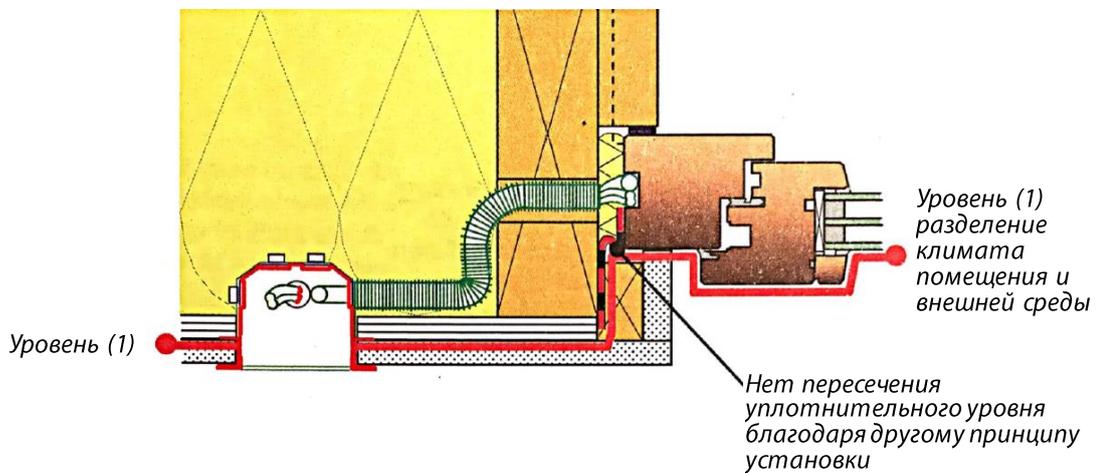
Уровень уплотнения со стороны помещения в узле примыкания окна в этом случае не нарушен электропроводкой.
